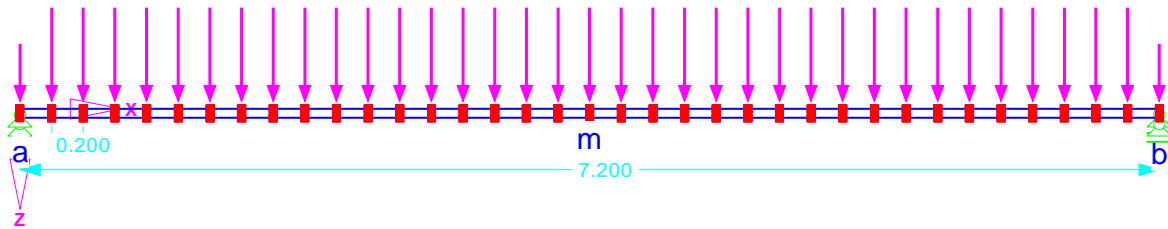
Belastung des Trägers mit Knotenlasten (Abmessungen in m)
